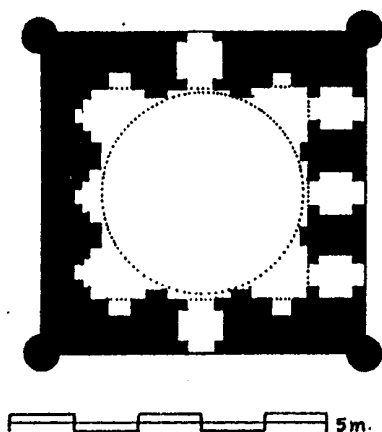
مسقط أفقي لتربة بايزيد يلدريم في بورصة
